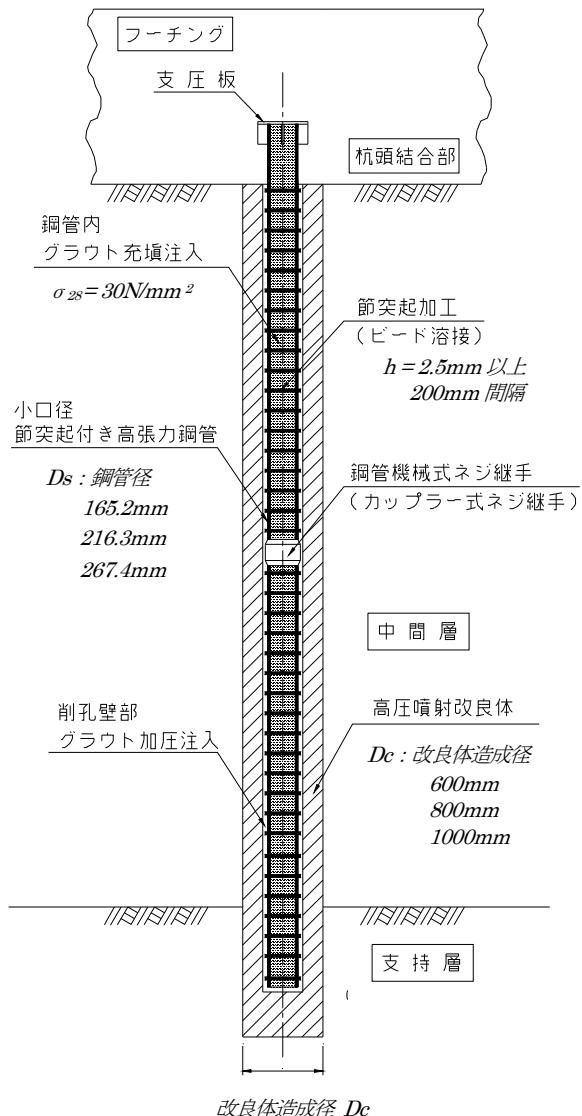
STマイクロパイル工法 タイプIIの構造
